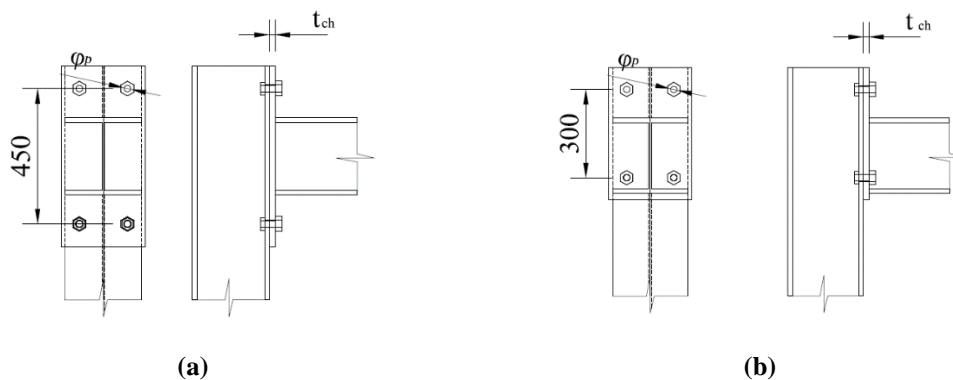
Detalhes de ligações viga-pilar: (a) análise típicas e (b) estudo neste trabalho.
